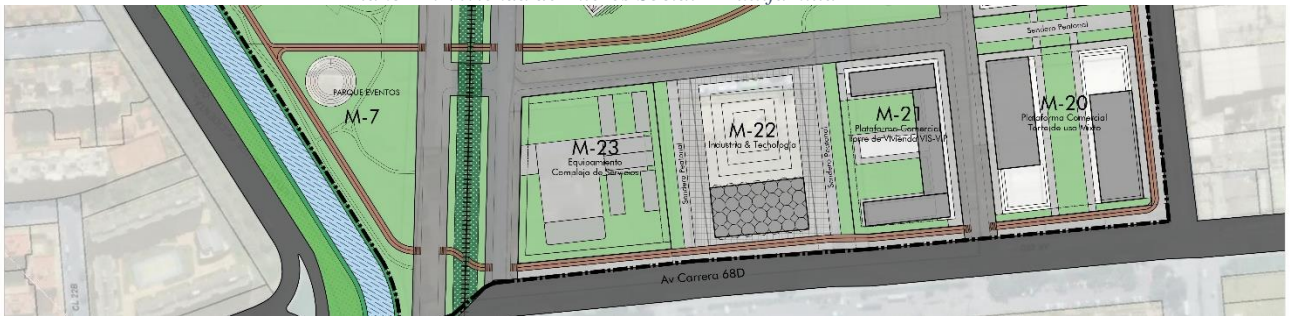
Propuesta arquitectónica PPRU INTEGRAL
